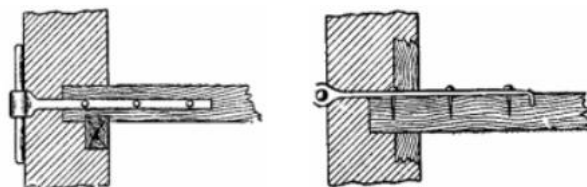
Ferrolho com ligação ao exterior da parede [6]
